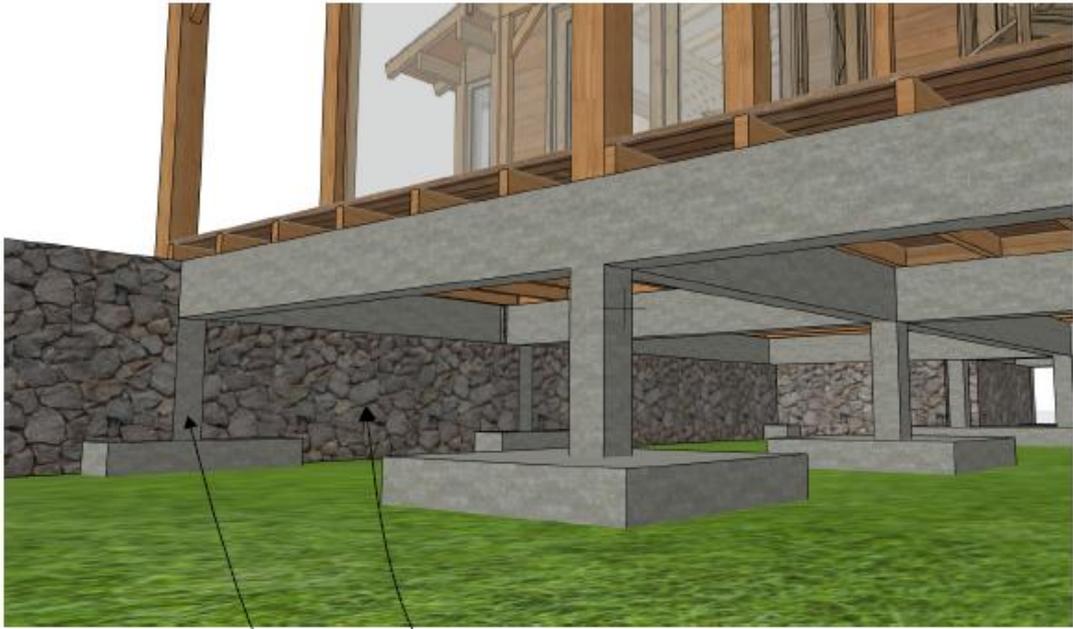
Detalhe dos pilares de concreto e elevação da estrutura
